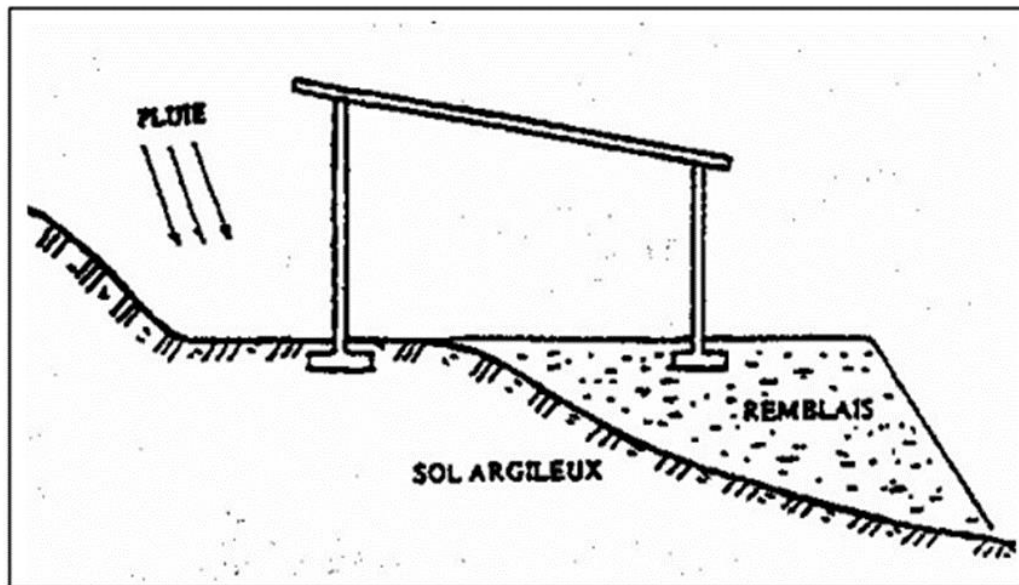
Une partie de la construction est fondée sur un remblai [13].
